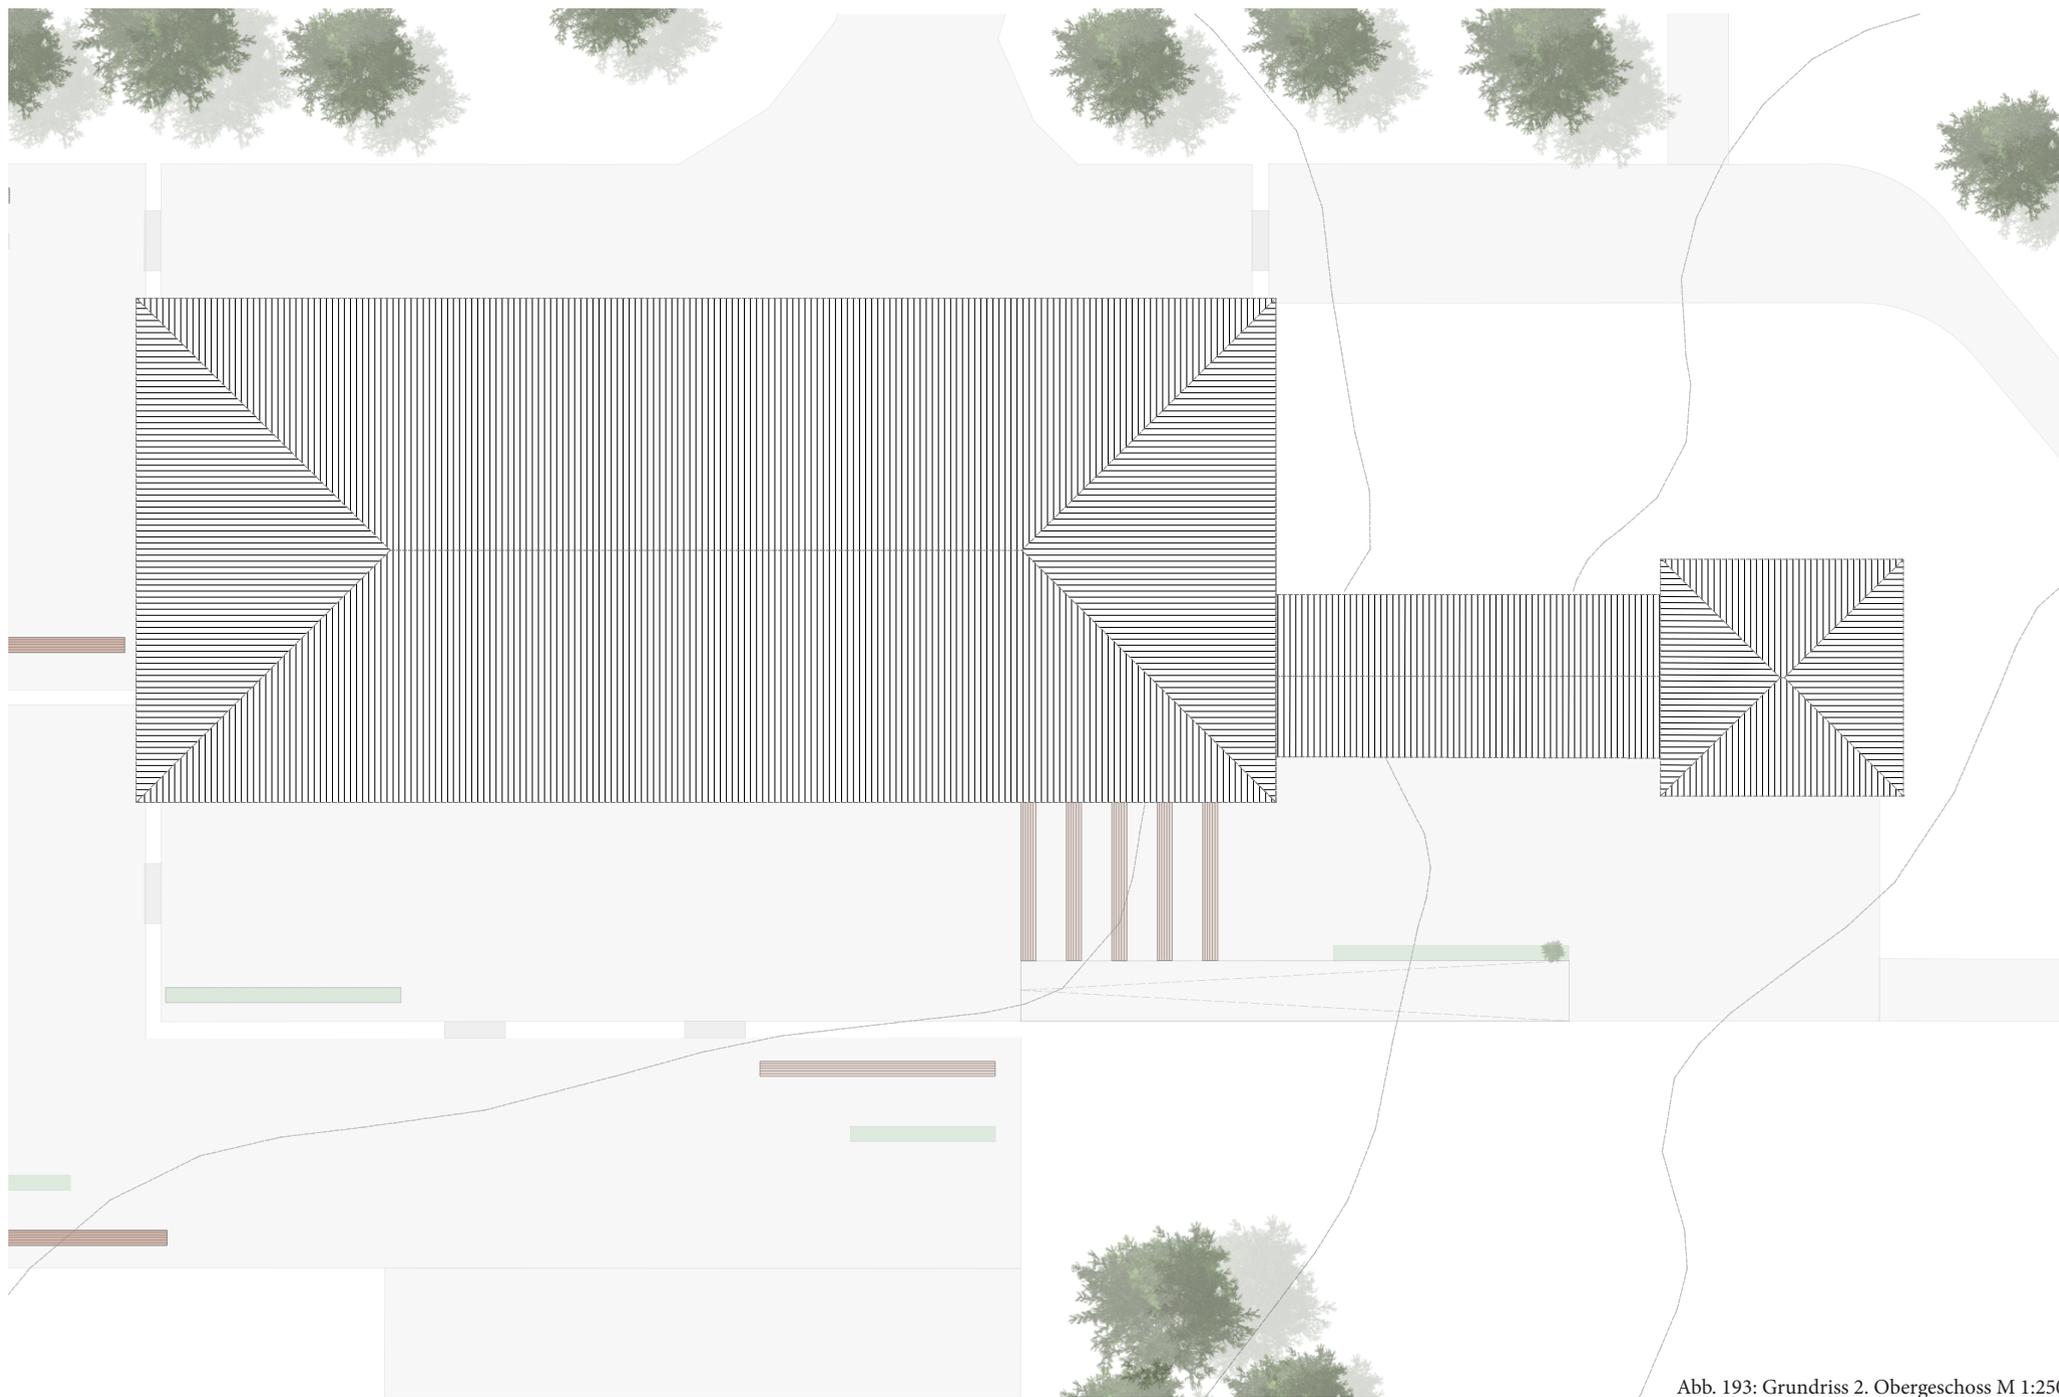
Grundriss 2. Obergeschoss M 1:250
